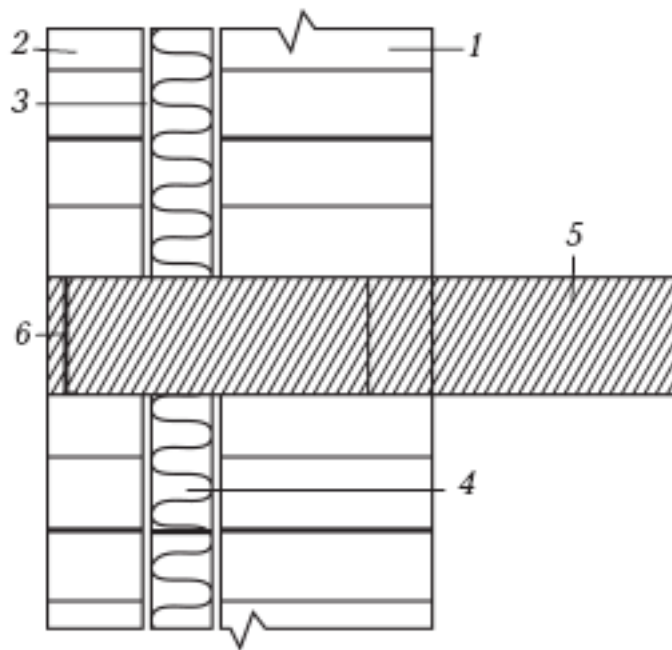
Устройство несущих поясов в защитно-декоративной стенке: 1 – внутренняя часть стены; 2 – наружная защитно-декоративная кладка толщиной 120 мм; 3 – воздушный зазор; 4 – теплоизоляционные плиты; 5 – несущая балка-пояс; 6 – мастика
